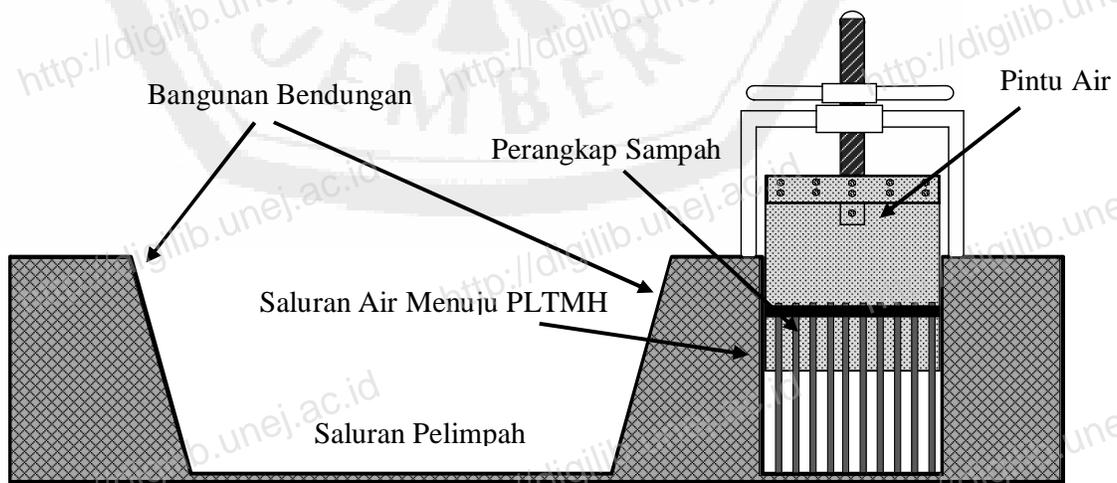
Bangunan bendung yang digunakan sebagai intake tampak depan
